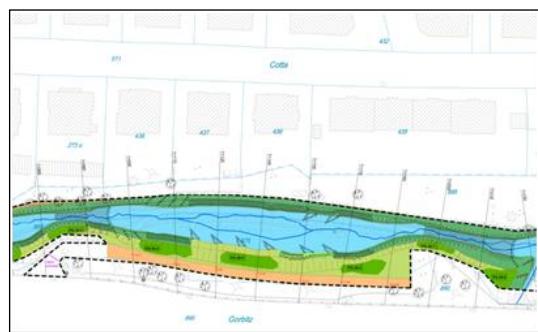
Planskizze: neumodelliertes Gewässerbett entlang der Coventrystraße von der Wilhelm-Franz-Straße bis zur Brücke Weidentalstraße
